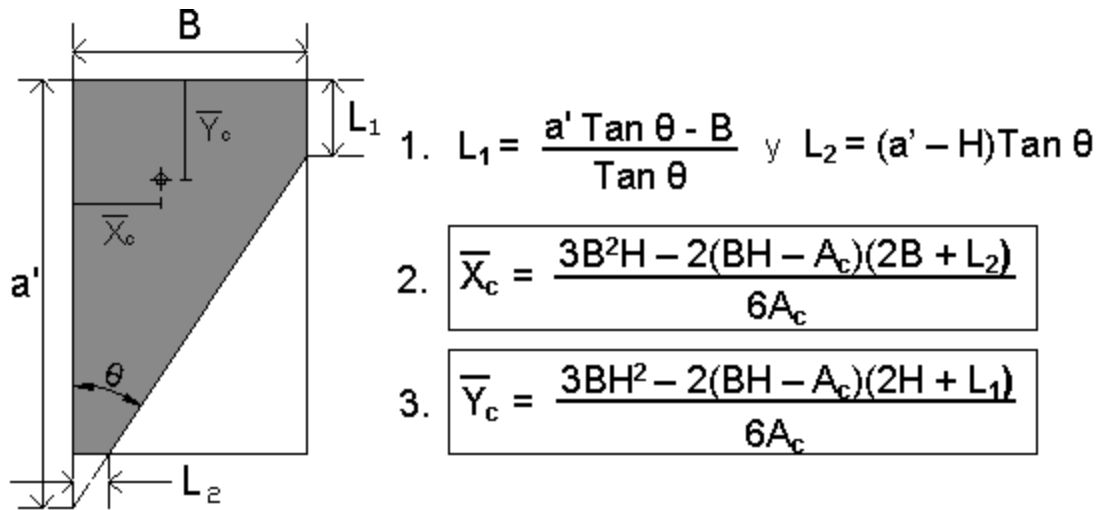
Área en compresión trapezoidal (tipo 3) en coordenadas X e Y
